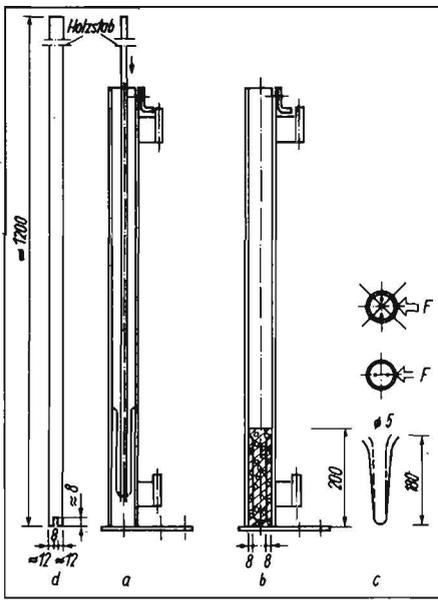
Stabilisierung des unteren Säulenbereichs durch einen Stahlbetonkern;
